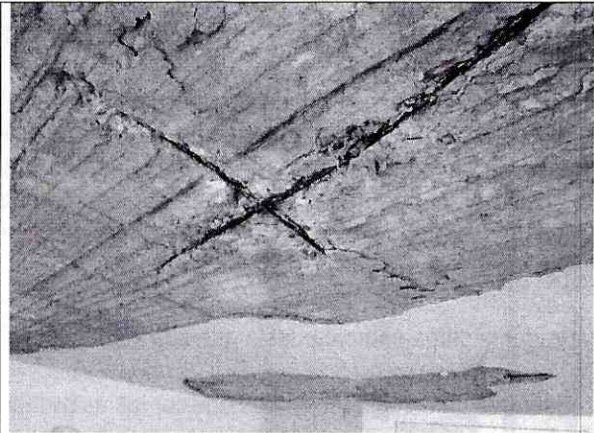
Corrosión del refuerzo de la cubierta, deflexión.
